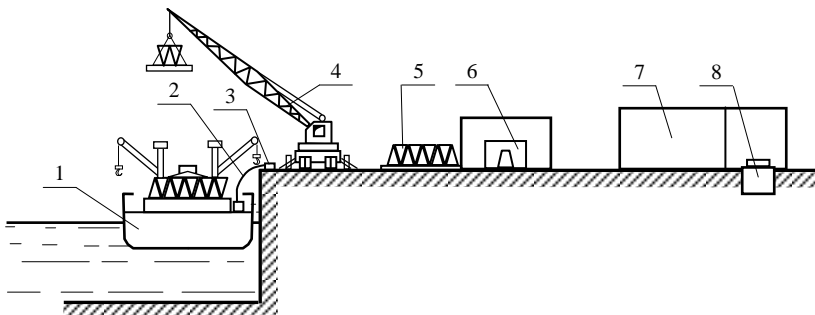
Схема причала для приема хозяйственно-бытовых стоков, фекалий и мусора:
